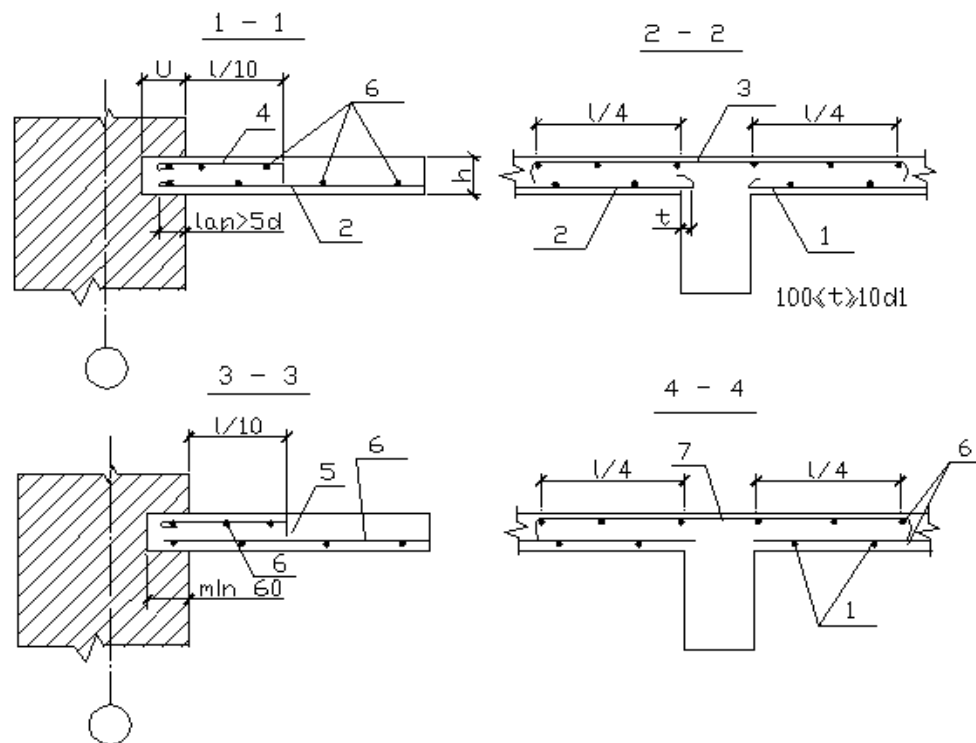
Армирование монолитных балочных плит в сечениях (см. рис.2.3) отдельными стержнями:
